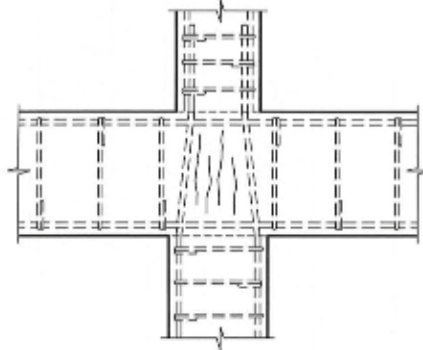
Fisuras verticales en nudo (Fuente: Calavera, 2005)
